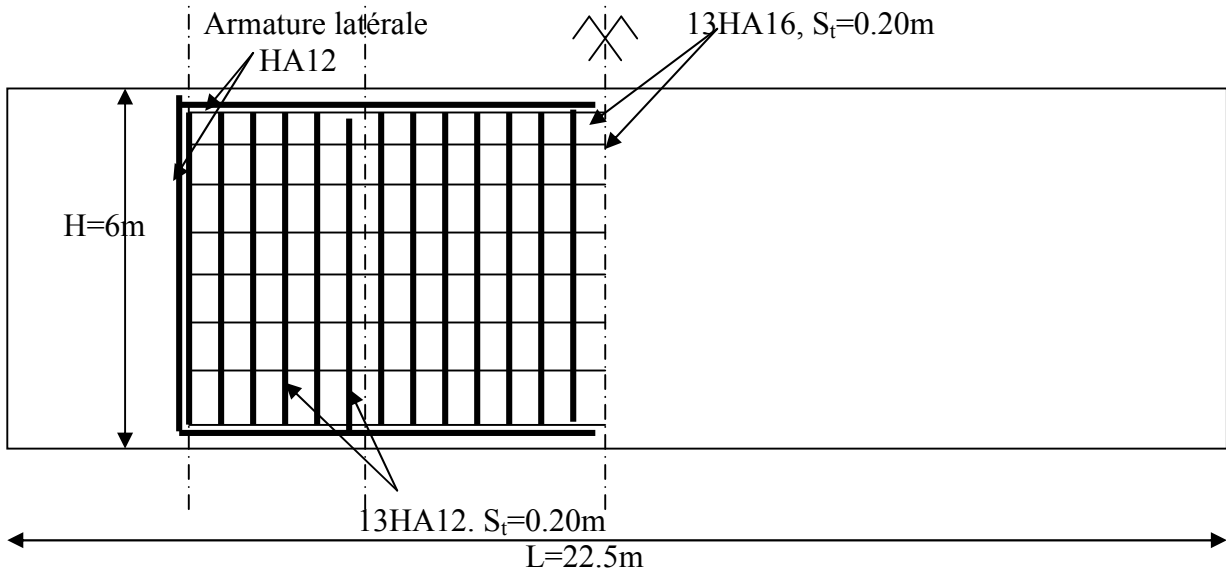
Ferrailage de la semelle (nappe supérieure).
